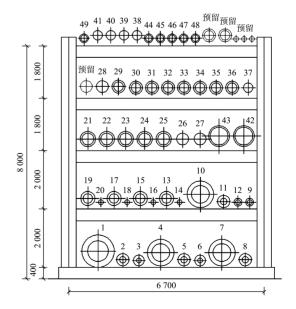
管线布置 (单位: mm) Fig. 2 Pipeline layout (unit: mm)
